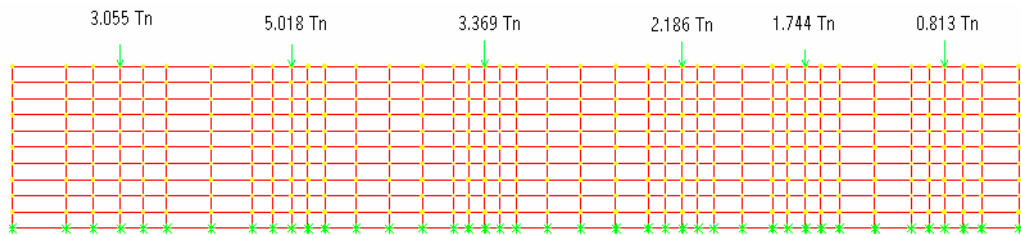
Carga muerta producido por las vigas sobre el muro.
